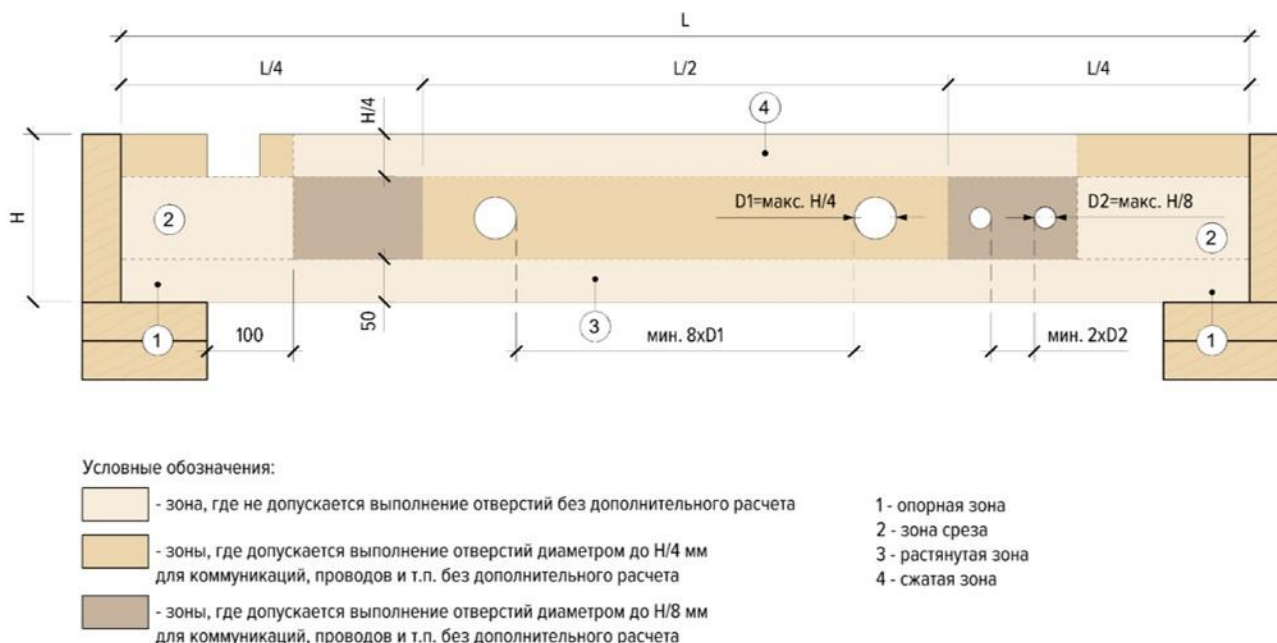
Размещение отверстий для коммуникаций в балках перекрытия
